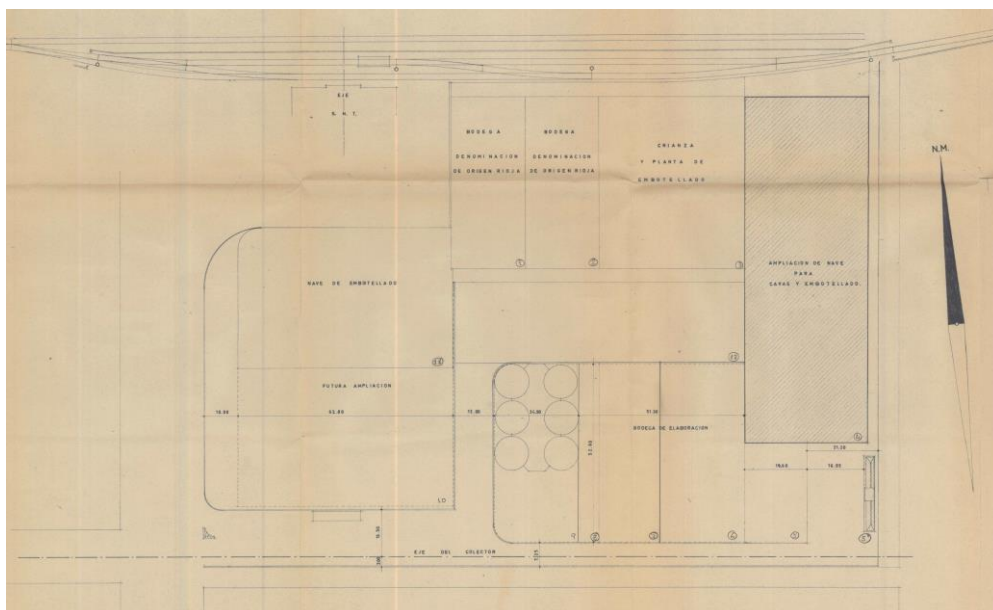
Plano de planta de bodegas Campo Viejo en su implantación en el polígono de Cascajos (Logroño).
